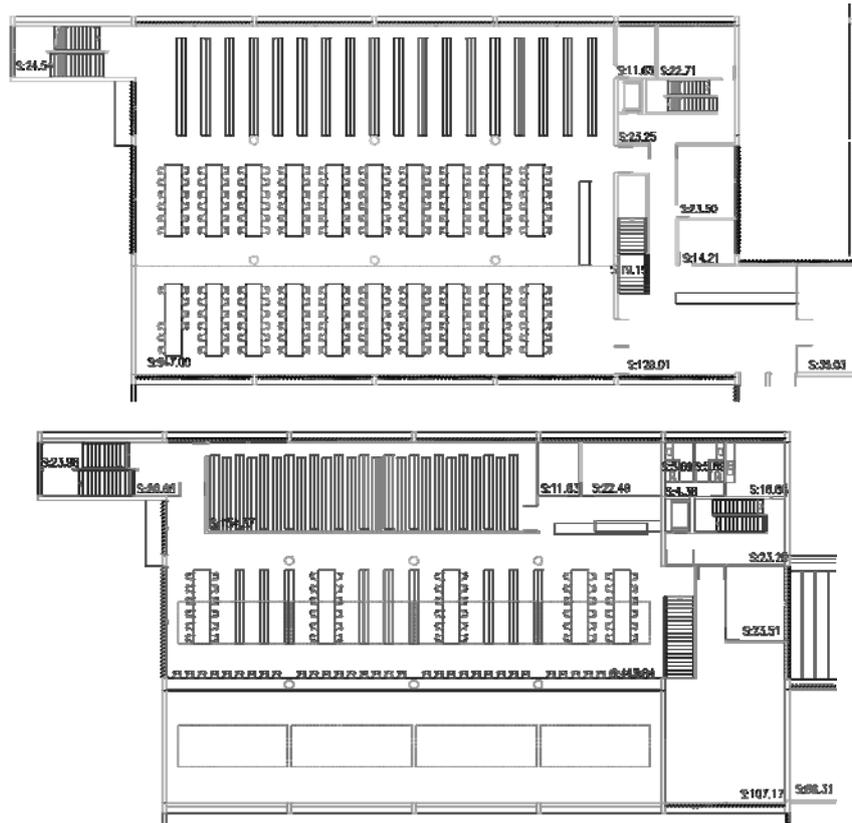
Localización y distribución de la biblioteca Hypatia de Alejandría en planta primera (imagen superior) y segunda (imagen inferior)
